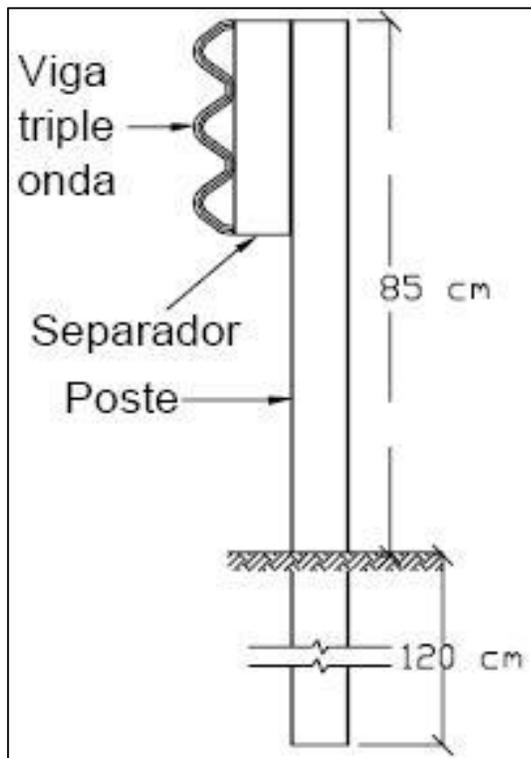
Sistema de amarre colapsable entre la viga y el poste de la barrera.
